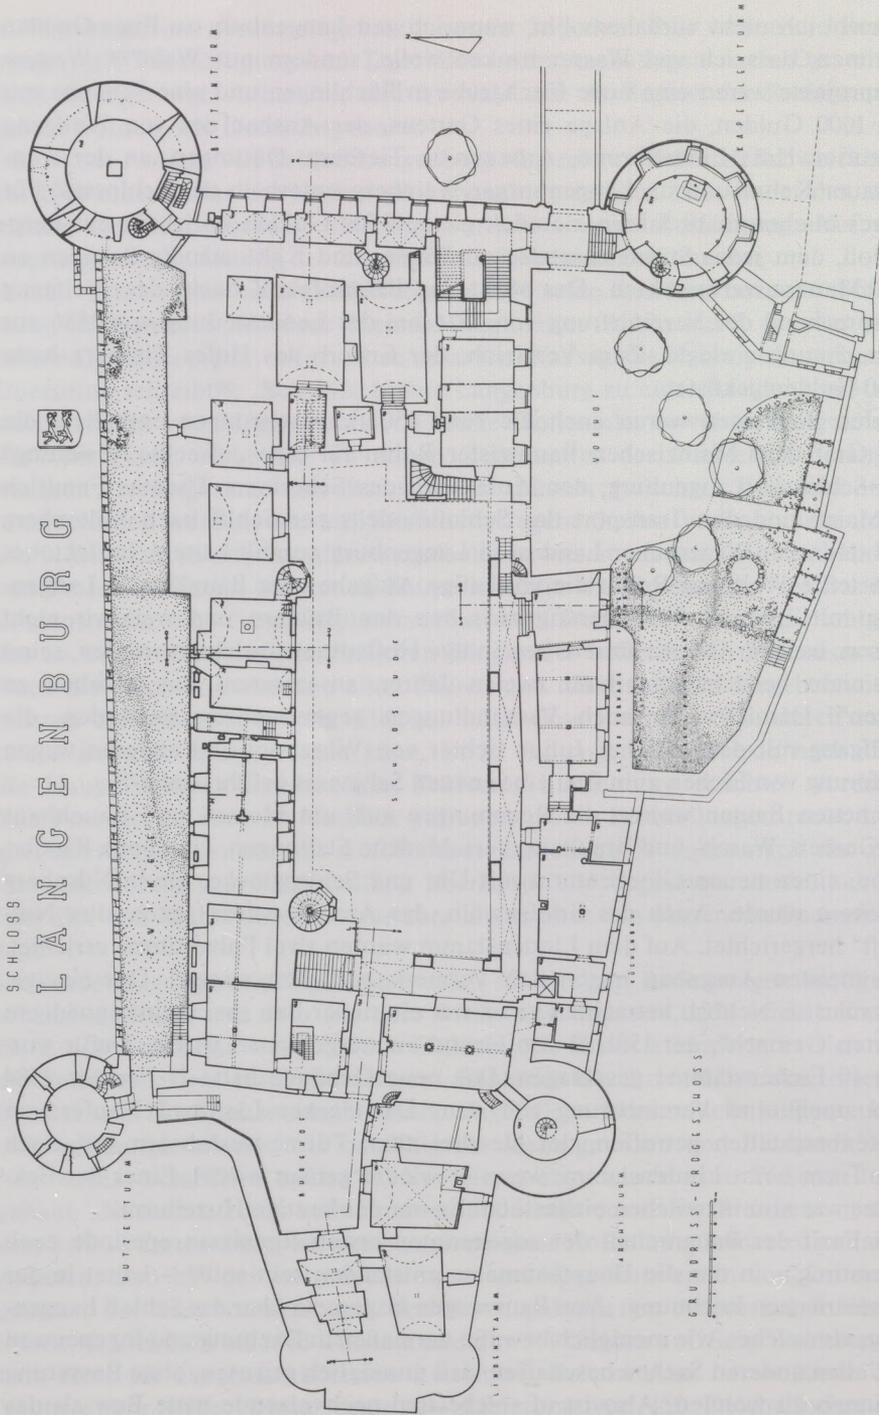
Grundriß des Erdgeschosses von Schloß Langenburg nach Doerfling, 1957.
